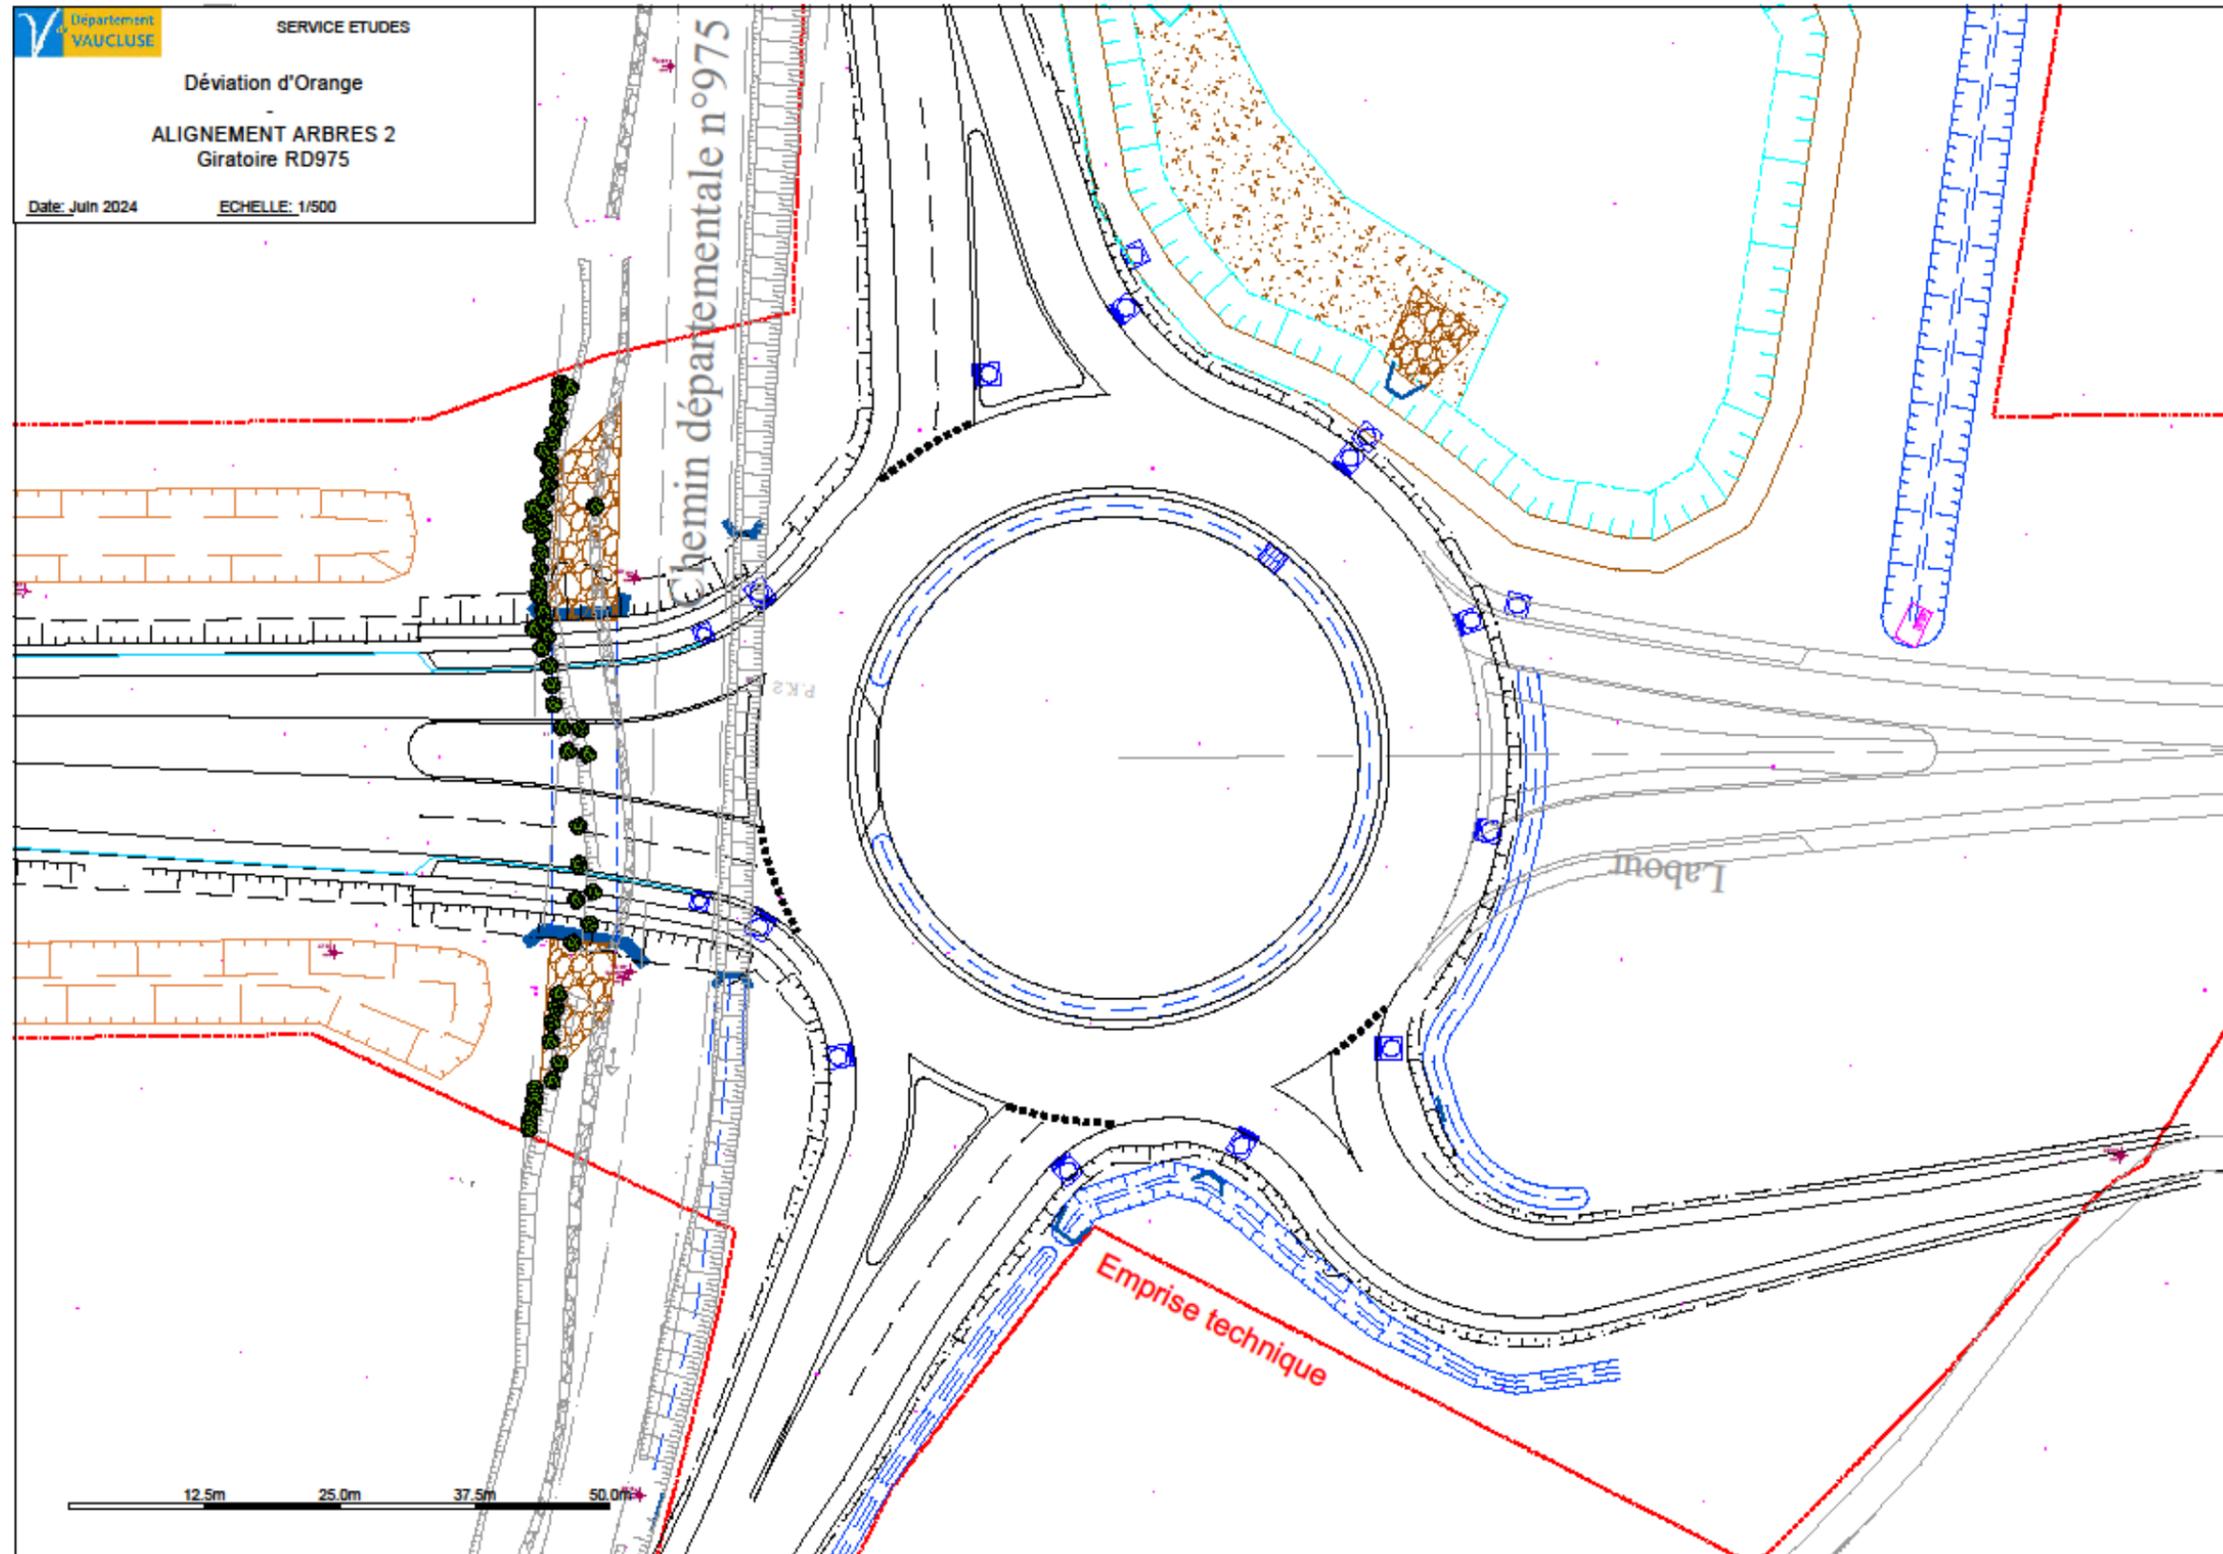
Plan du giratoire de RD975 - alignement 2 (Source : CD84)
